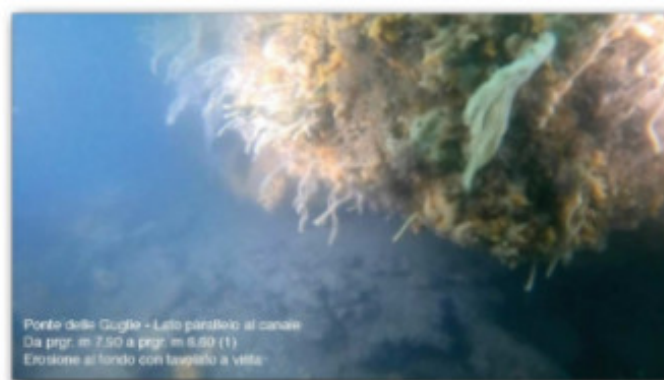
Foto subacquee che evidenziano l'erosione del fondo e i pali a vista delle spalle del ponte
